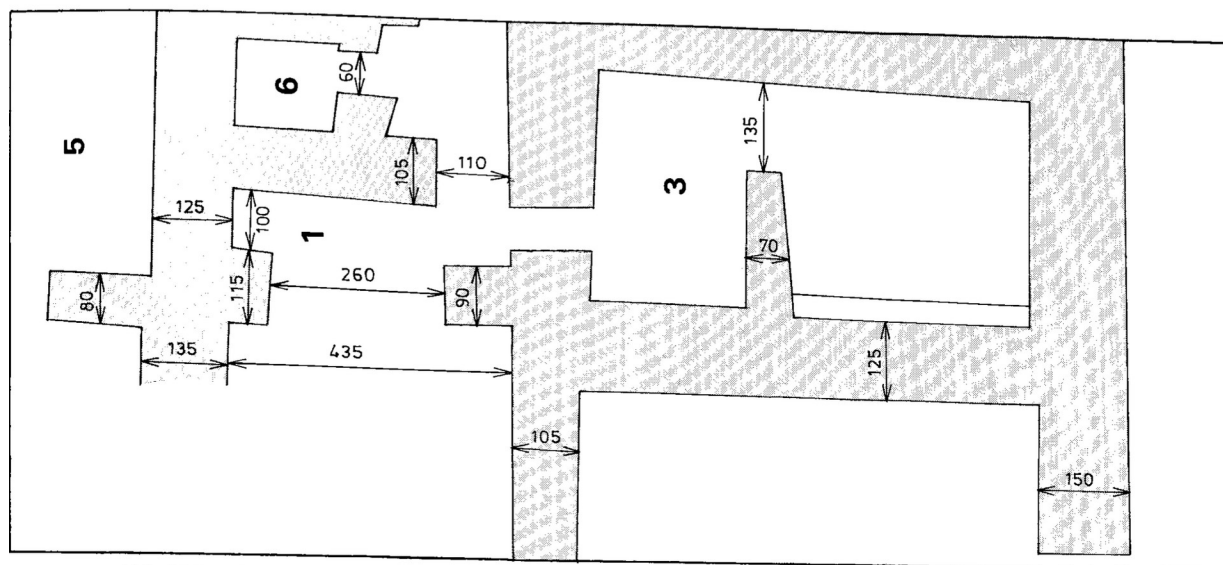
Uruk-Warka. Parthisches Haus: Bauschicht II. Vermaung der Tr von Raum 1, 3 und 6 aus dem Aufnahmeplan im M. 1:100 abgegriffen. M. 1:100.
